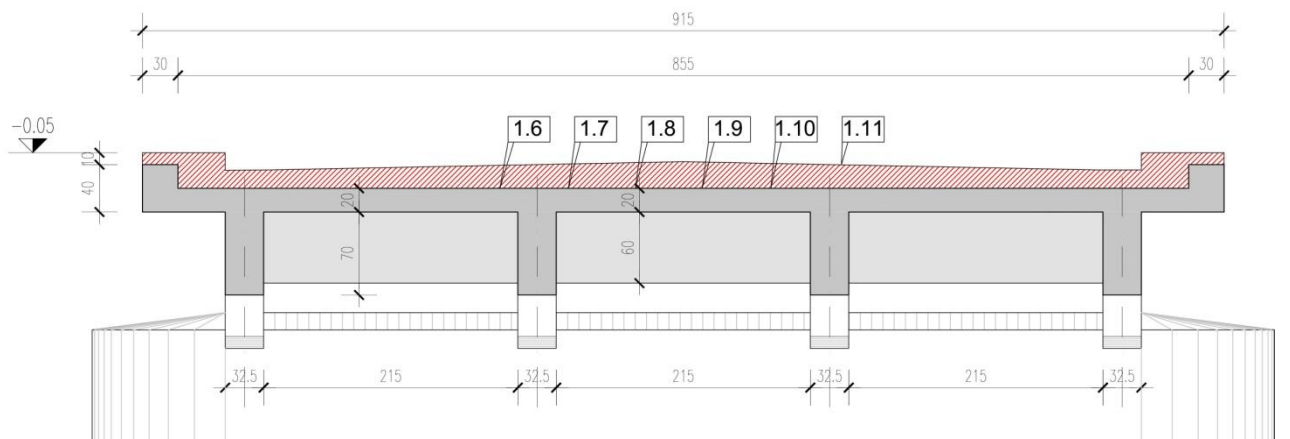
Sezione tipologica impalcato - fase di ricostruzione
